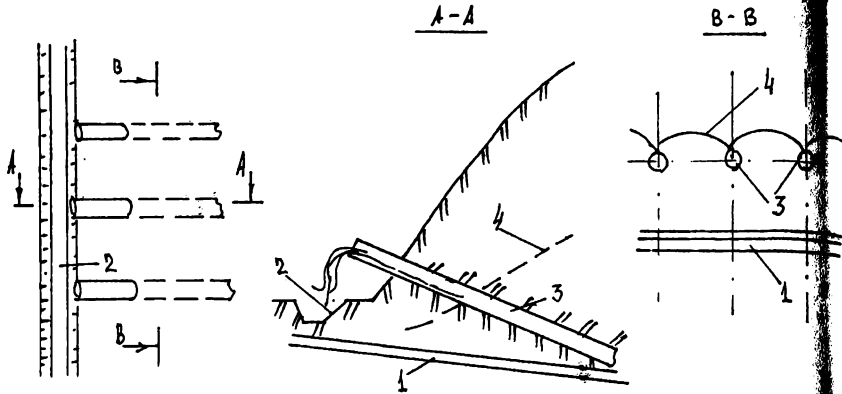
План, продольный и поперечный профили дренажа из скважин:
